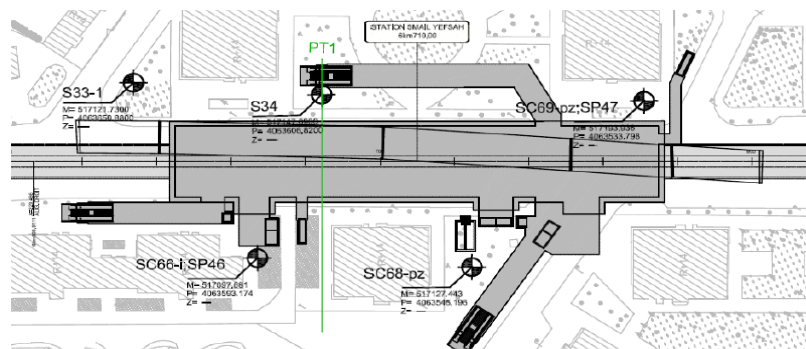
Plan d'implantation des Sondages de la station Smail Yefsah
